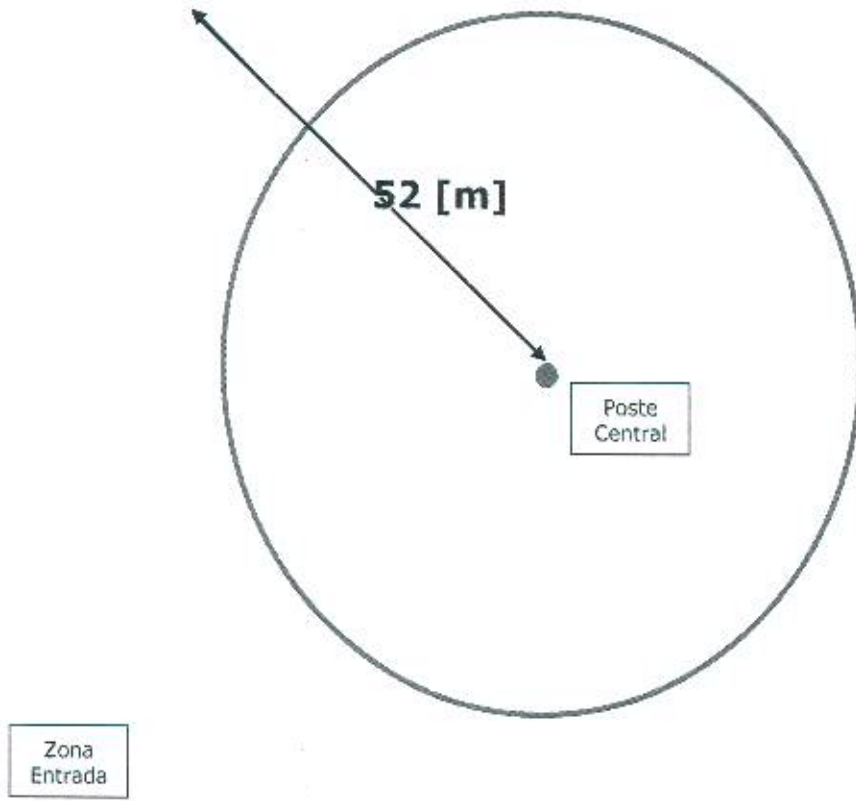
Planta Anfiteatro Quinta Vergara.
